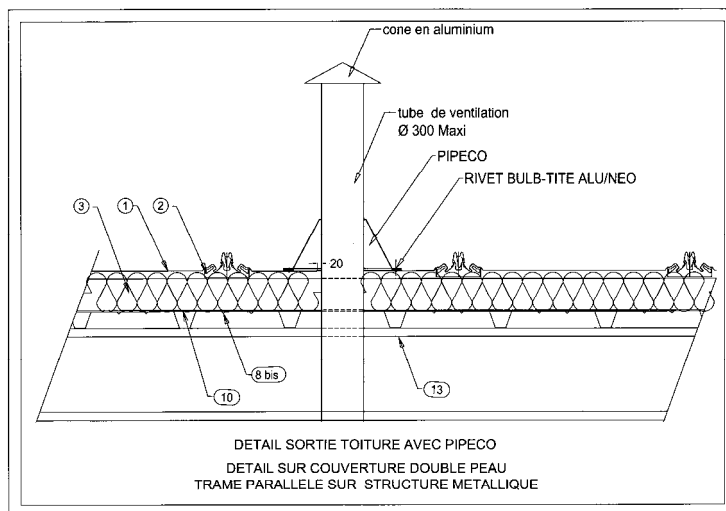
Raccord sur conduit en pénétration (épaisseur 1 mm)
